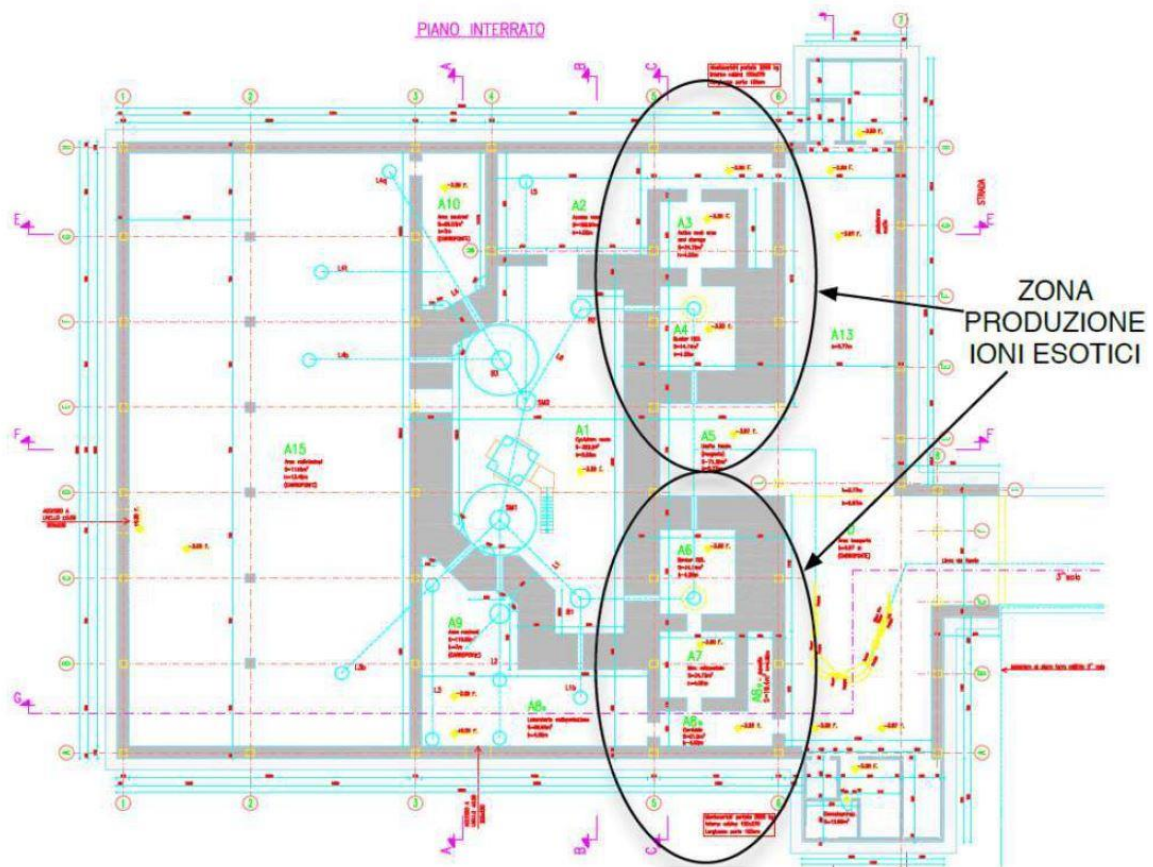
Planimetria del piano interrato dell'edificio SPES.
